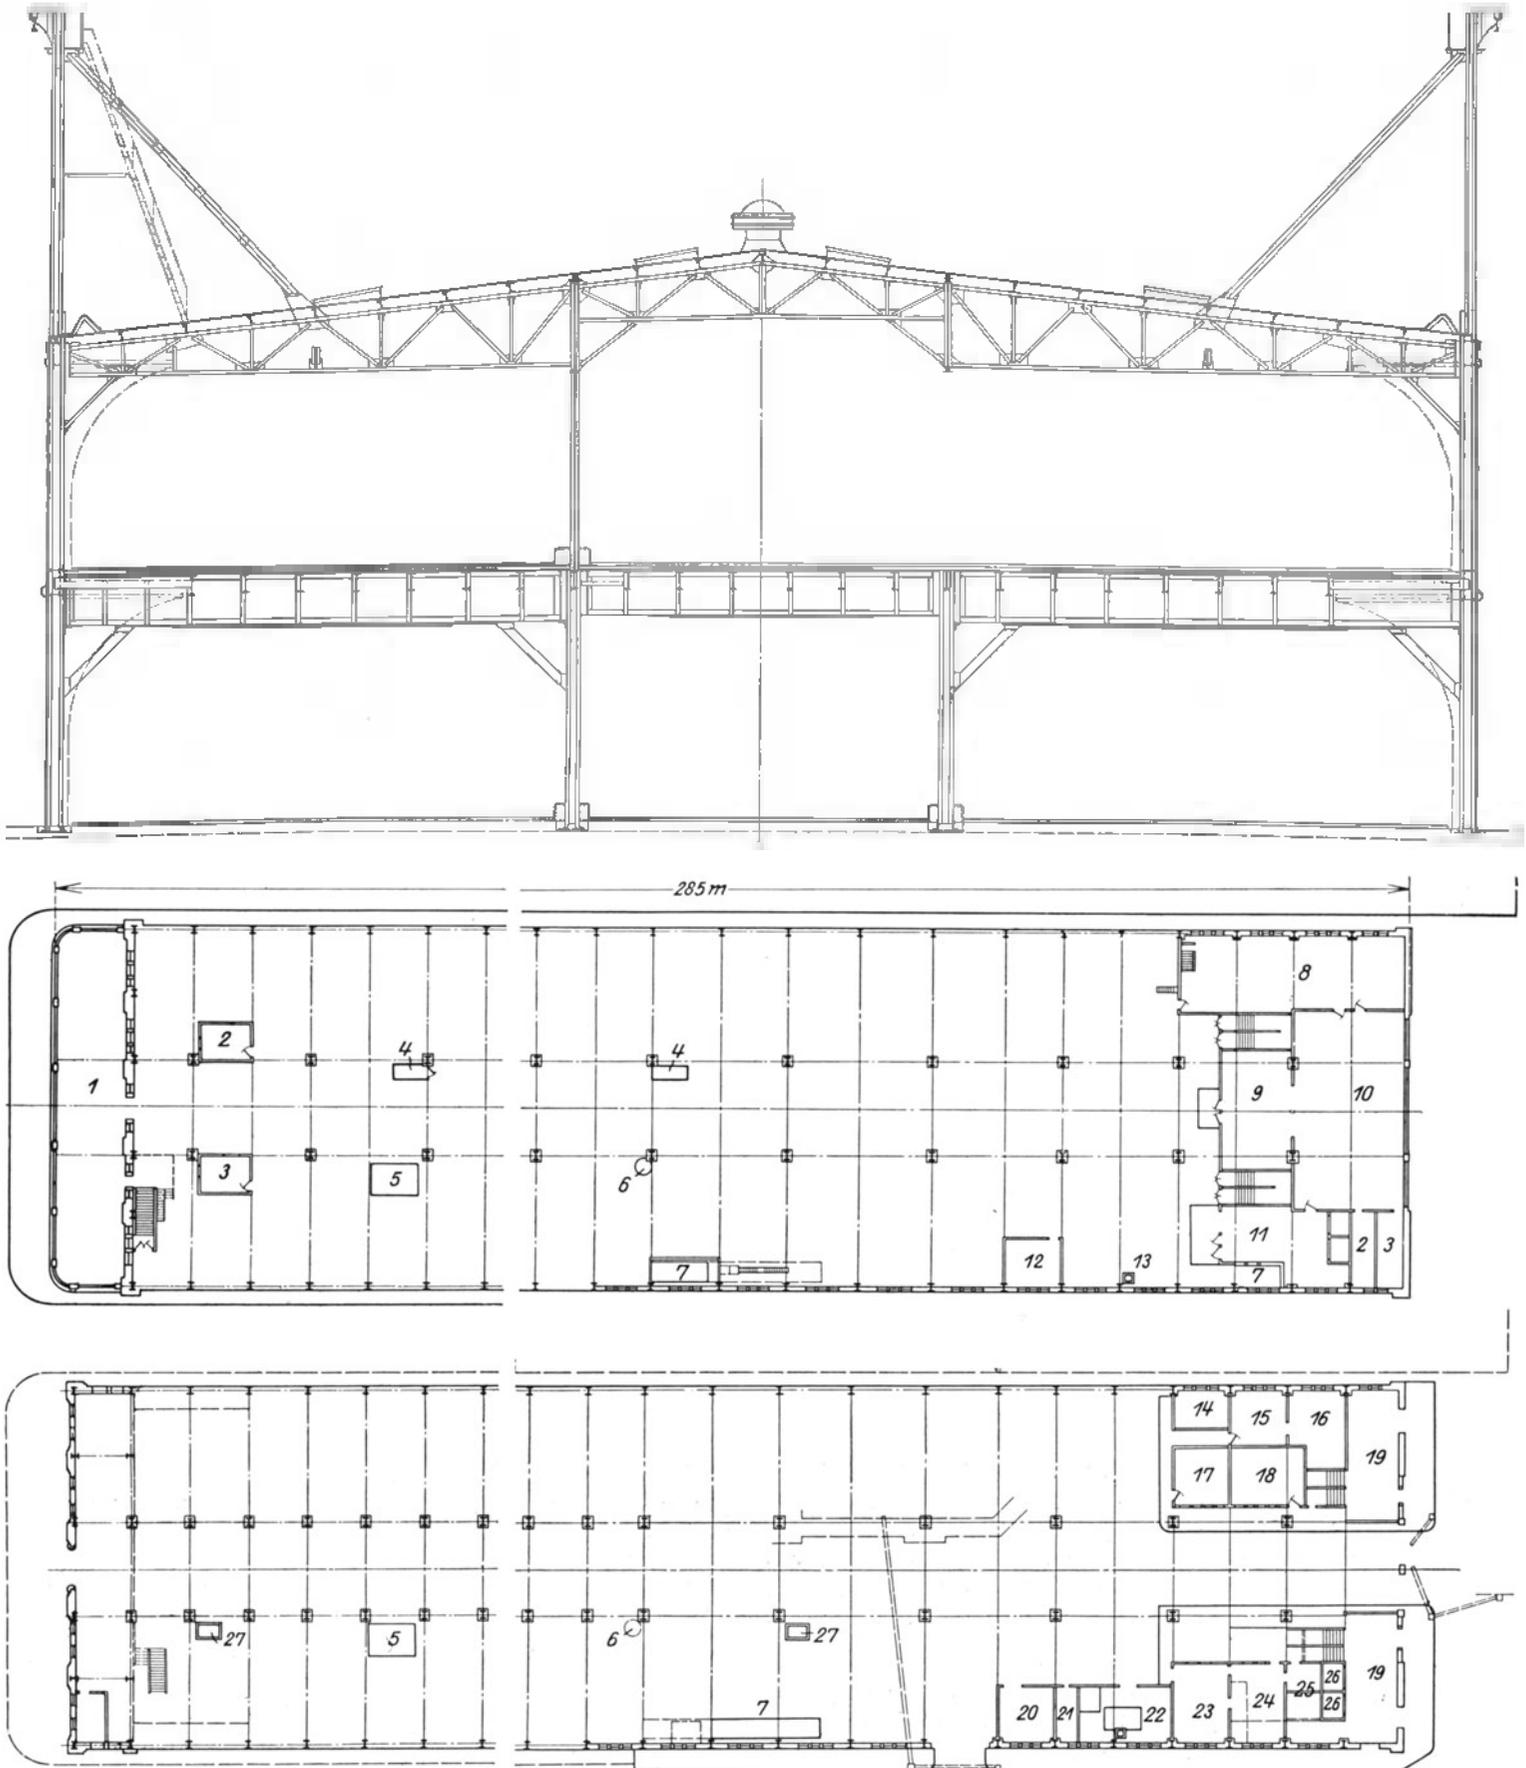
Pier 84. Querschnitt und Grundrisse des neuen Piergebäudes.
